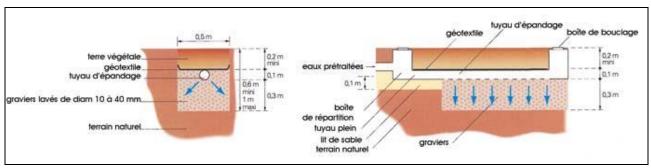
Schéma d'une tranchée d'infiltration (source : Landru.fr)
